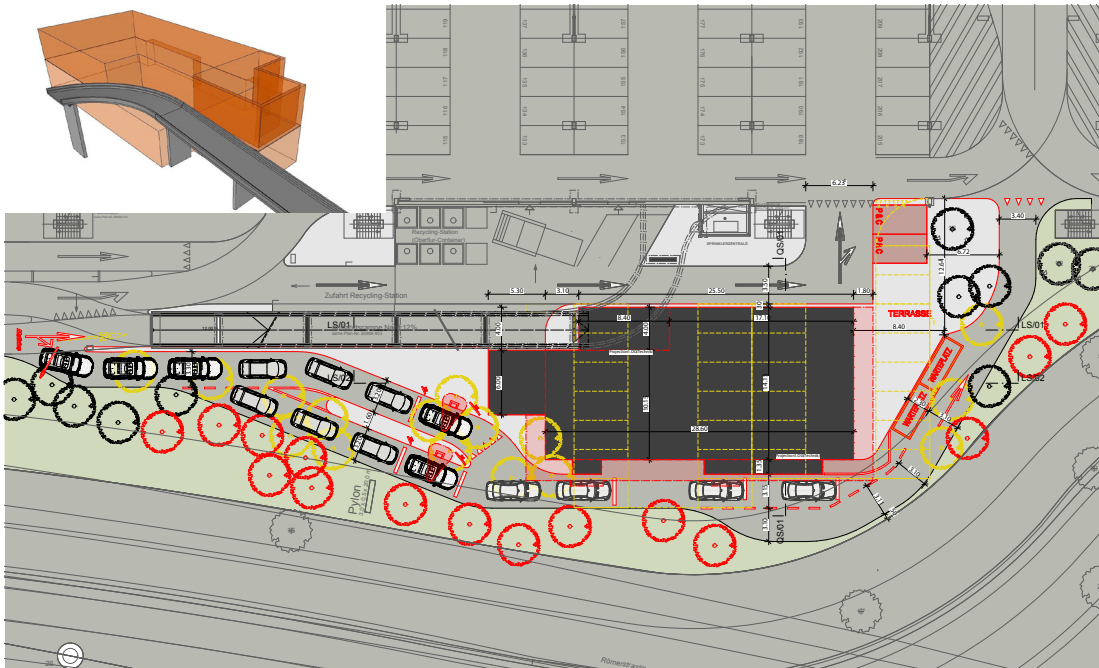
Vorprojektplan des Restaurants mit Drive-In; gelb = Abbruch/Baumrodung, rot = Neubau/Baumpflanzung
